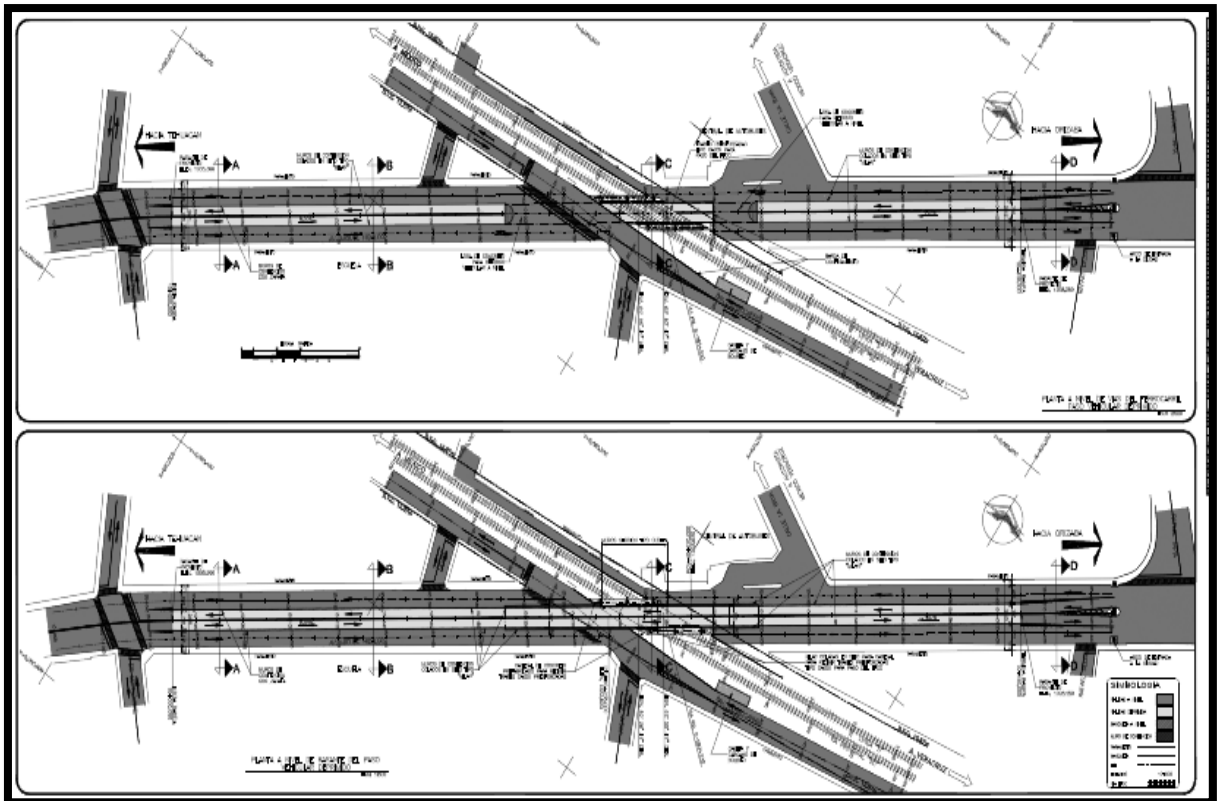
Detalle de planos geométricos, donde se observan las plantas generales del mismo proyecto: PIV "Santa Rosa".
